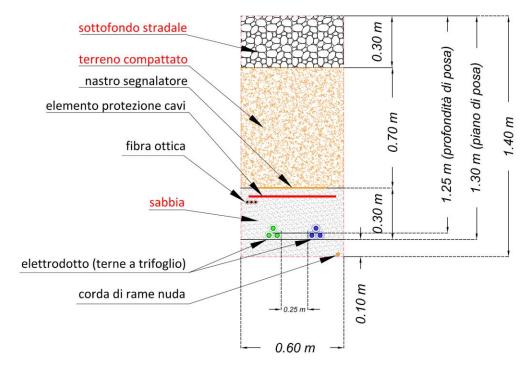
Sezione scavo per cavi direttamente interrati (profondità di posa: 1,25 m)
